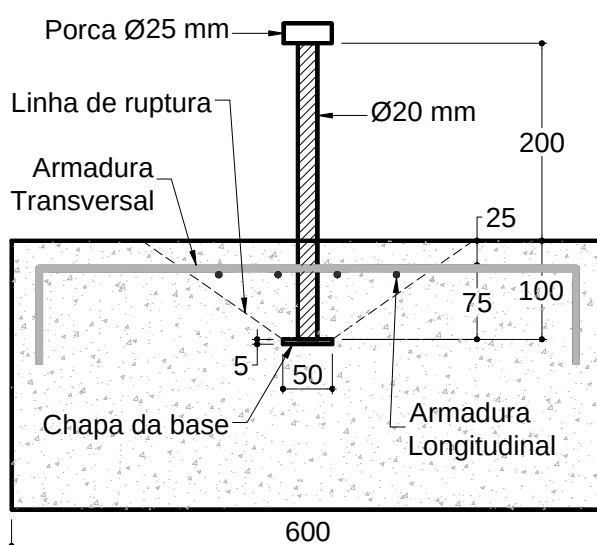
Disposição genérica da armadura de flexão dentro do cone de concreto.
